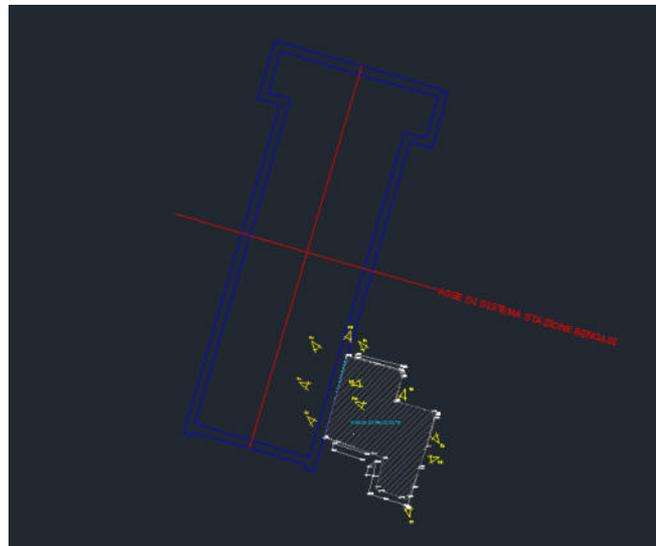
Ubicazione della vasca rispetto al corpo principale della stazione della Metropolitana
